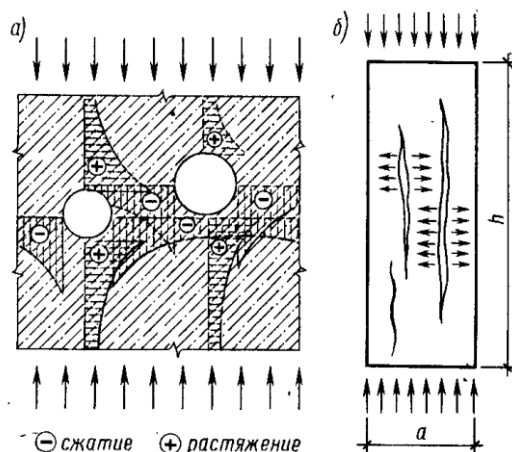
Схемы напряженного состояния и разрушения бетонного образца
